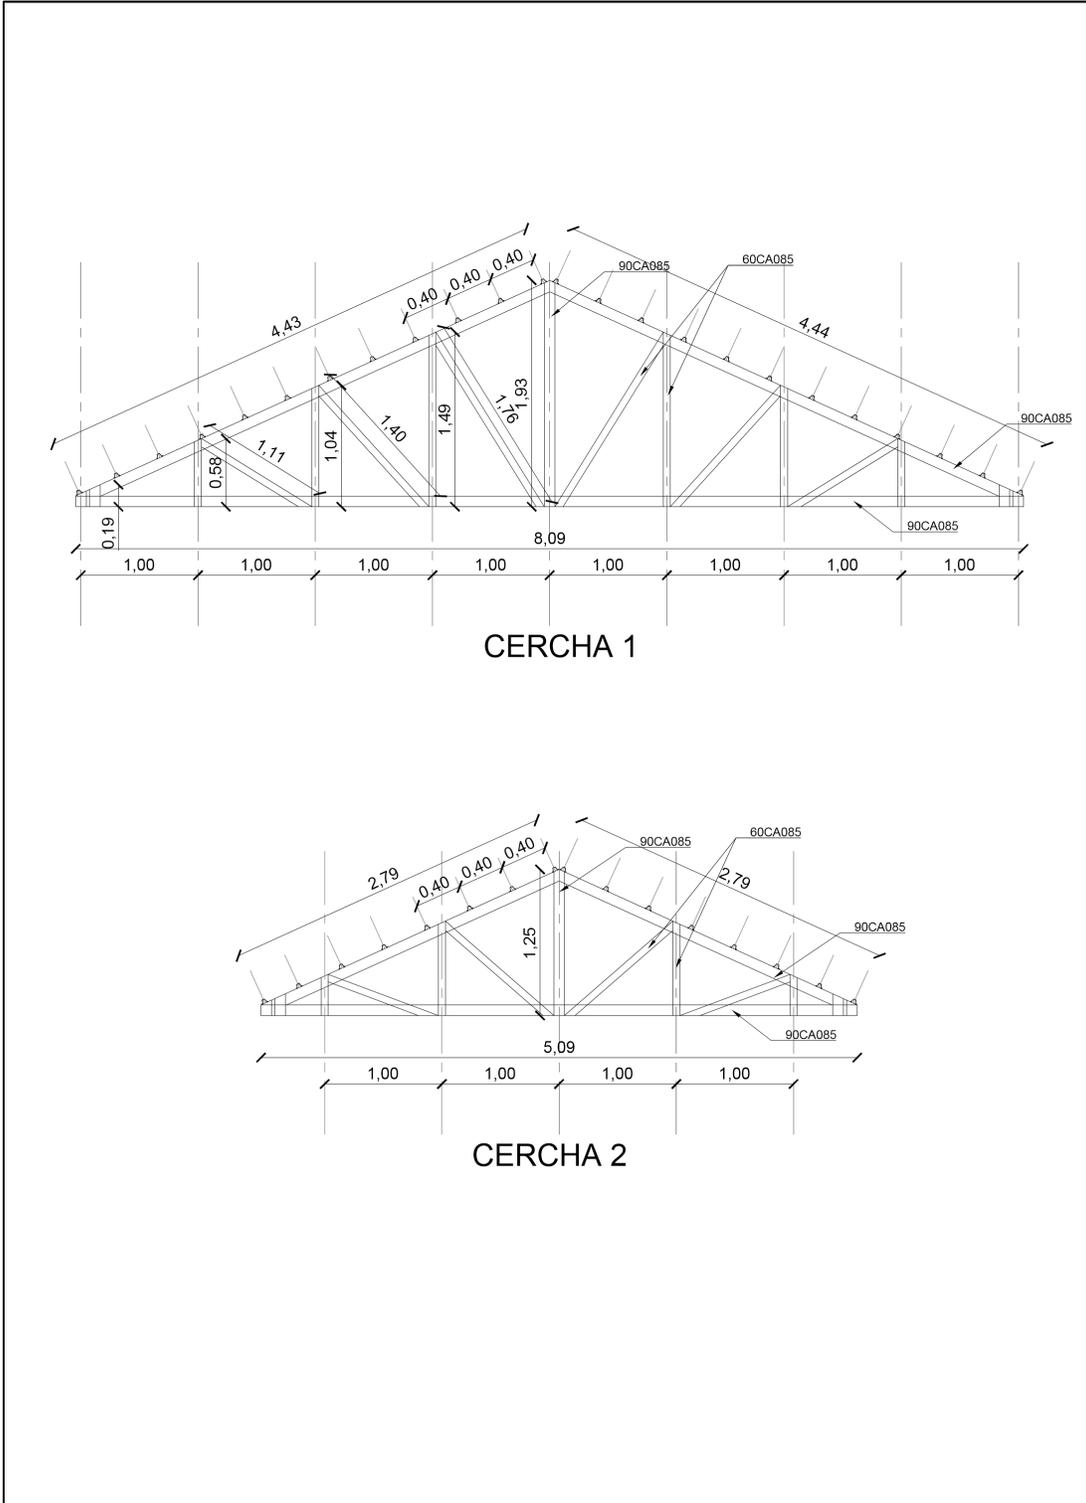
Elevaciones de estructura de techumbre modelo acero galvanizado
